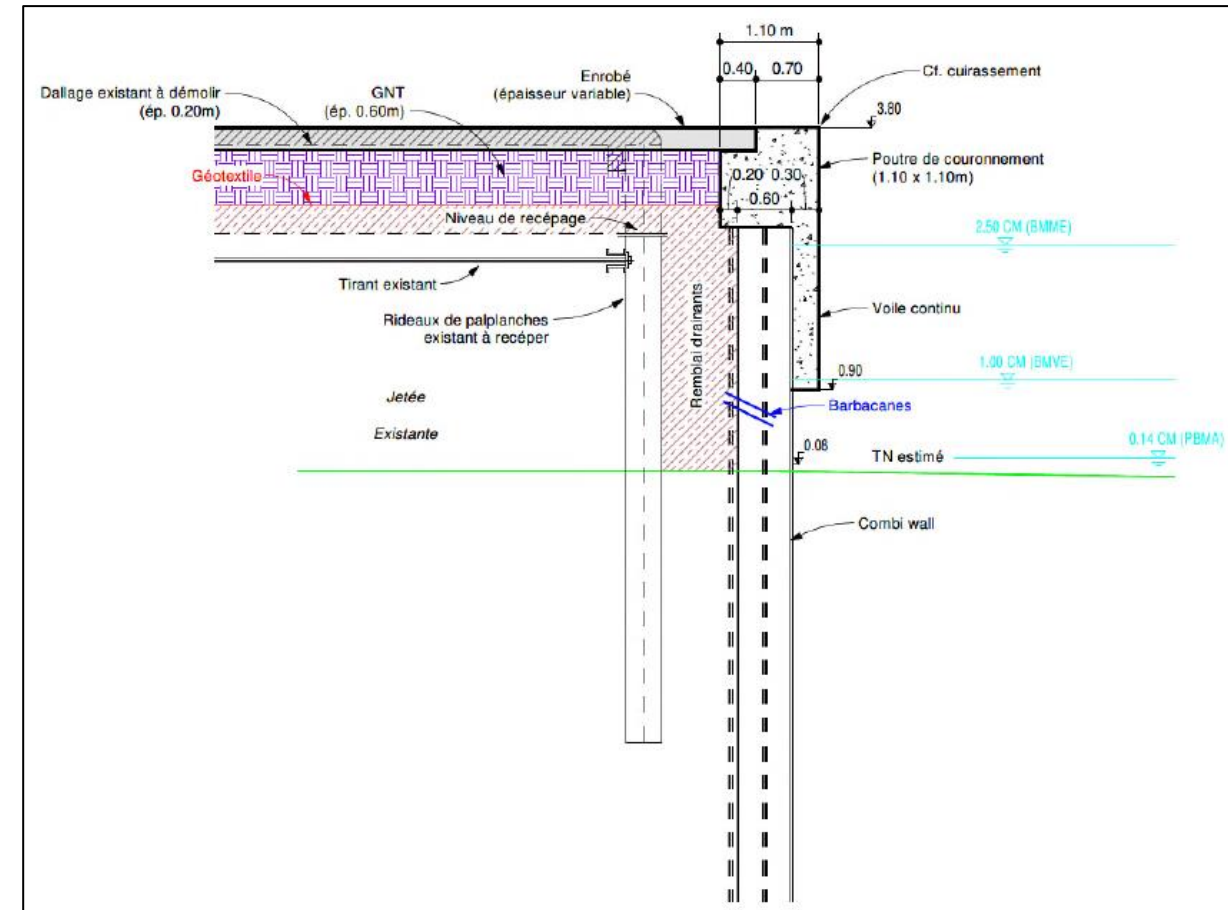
Coupe transversale du rideau mixte en rempiètement.
